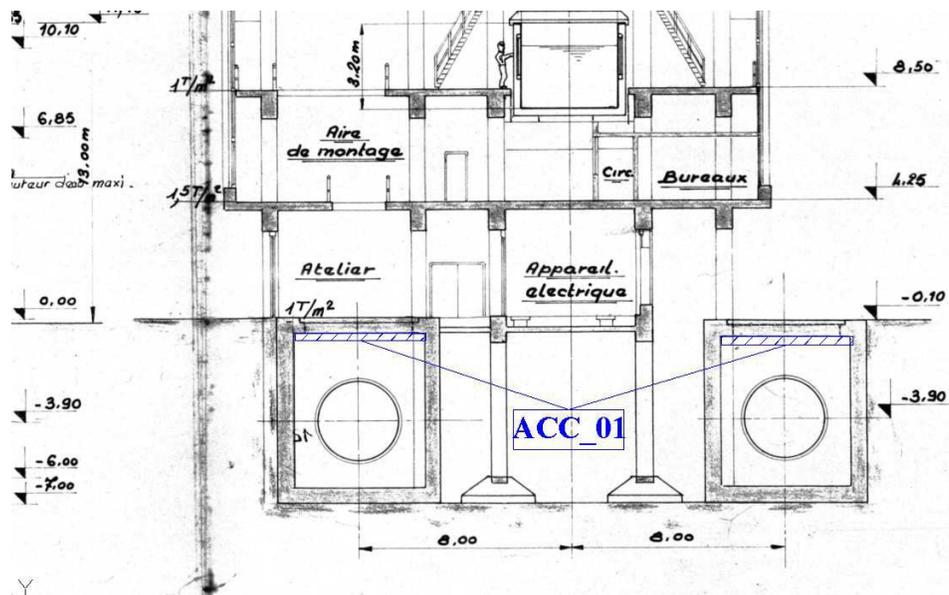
individuazione dei solai oggetto dell'intervento ACC 01 (sezione trasversale)
